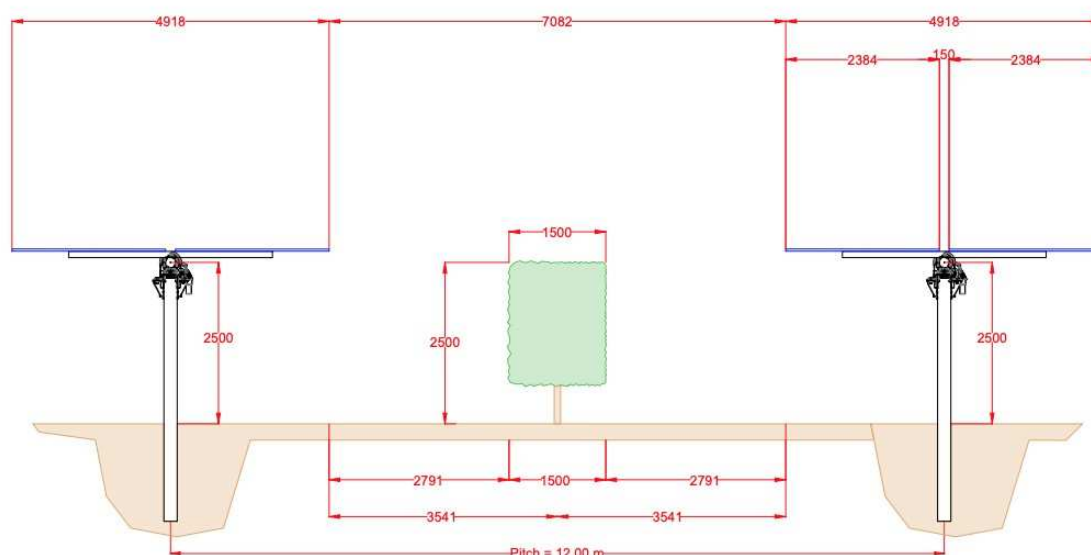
Sezione trasversale dell'impianto AGFV (Stralcio Elaborato El 026)
